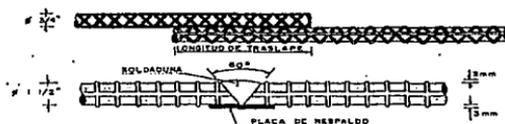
Detalle de traslape y soldadura de varillas
